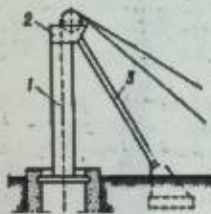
Схема копра: 1 — станок; 2 — головка; 3 — укосина.
